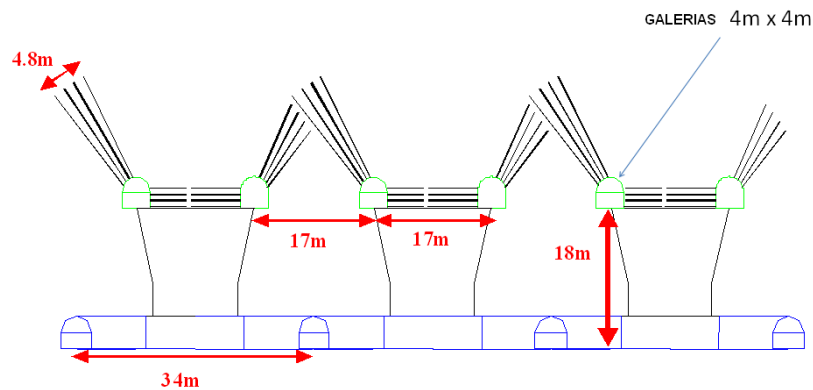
Hundimiento avanzado con corte inclinado, Palabora (undercutting workshop, 2008)
